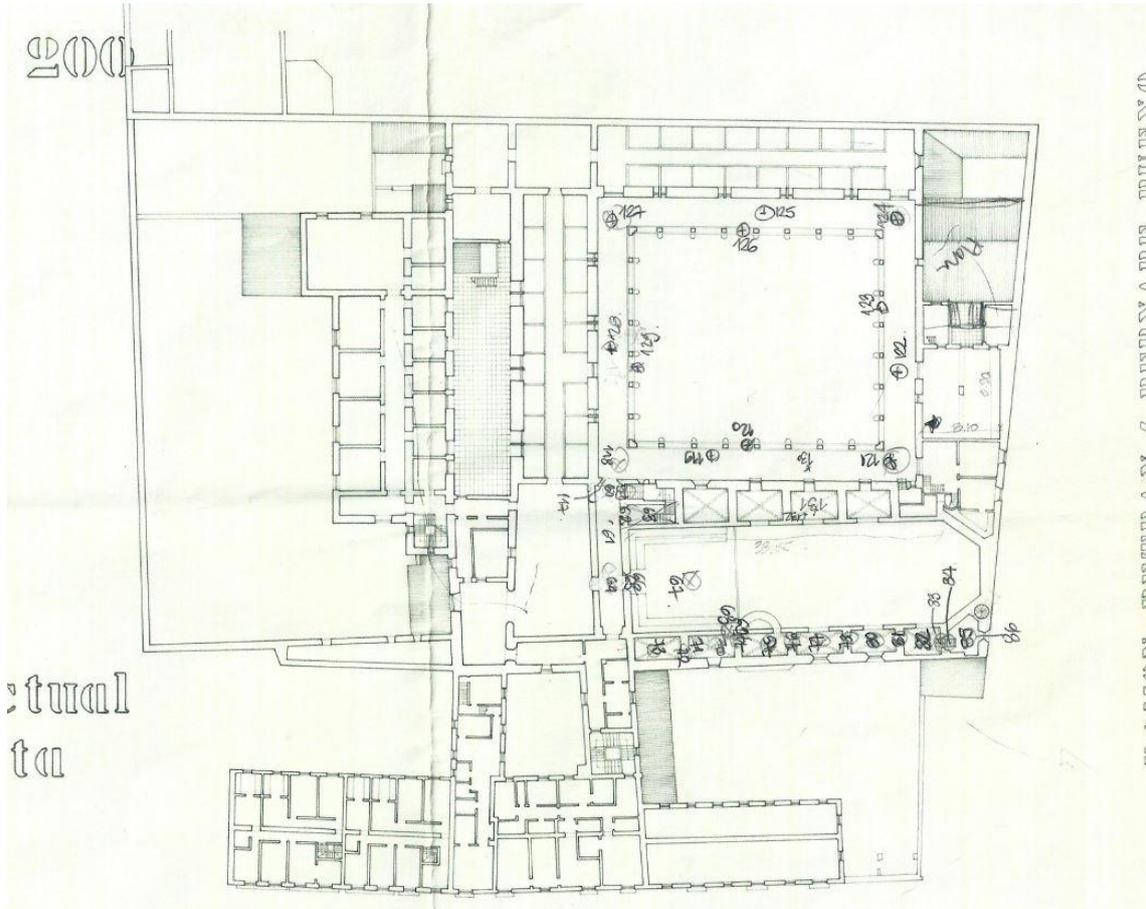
Plano de situación de las estaciones del escáner láser de la primera planta del claustro.
